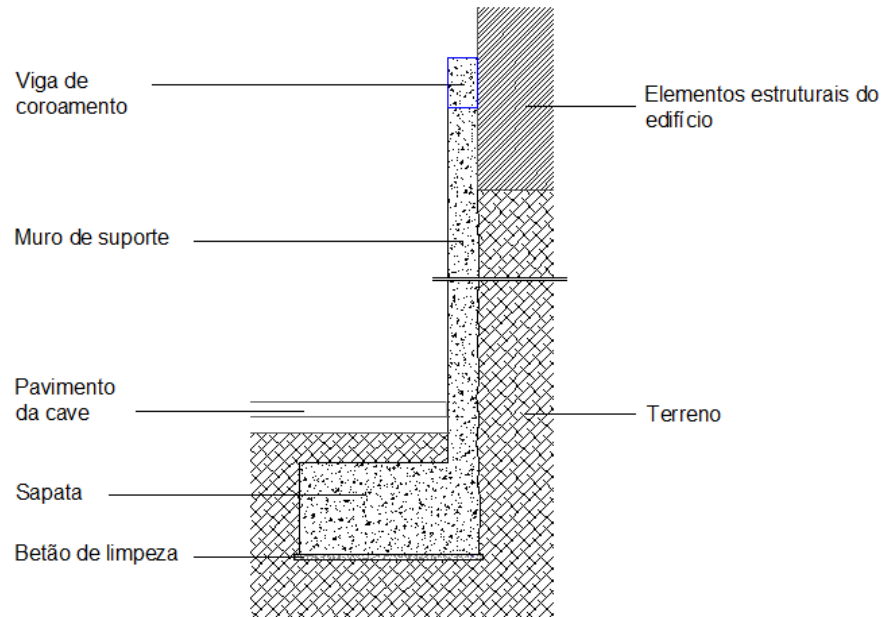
Pormenor construtivo do muro de suporte da cave (adaptado de [42])
